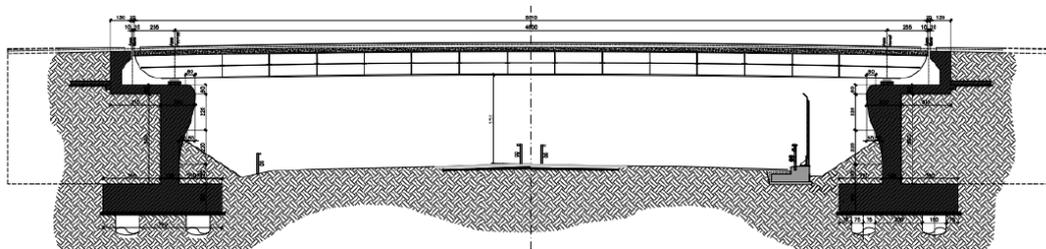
Sezione longitudinale dell'impalcato (Fonte: Allegati alla Lista di controllo)
